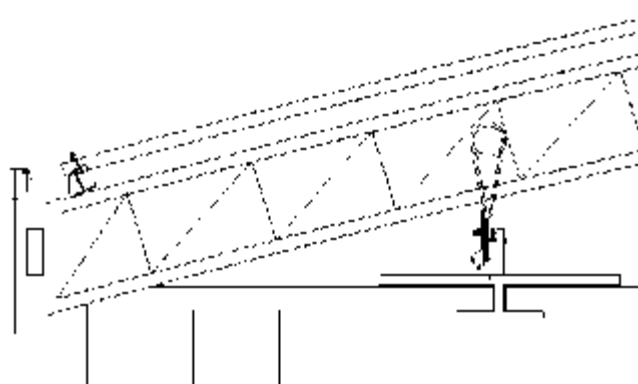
Estructura de techumbre. Fuente: Elaboración propia.
